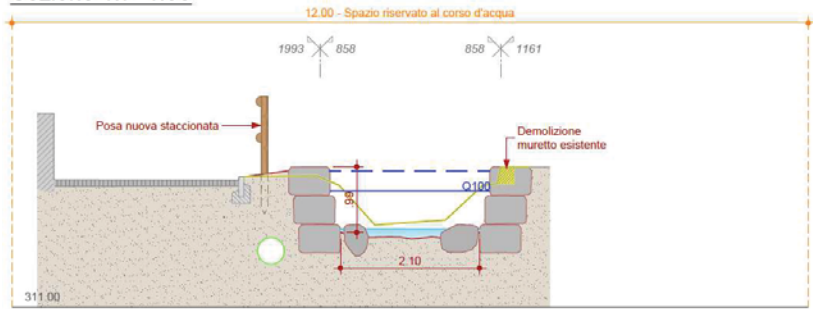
Raccomandazione progettuale nel caso di scogliere realizzare con massi calcarei irregolari: sezione tipo.
